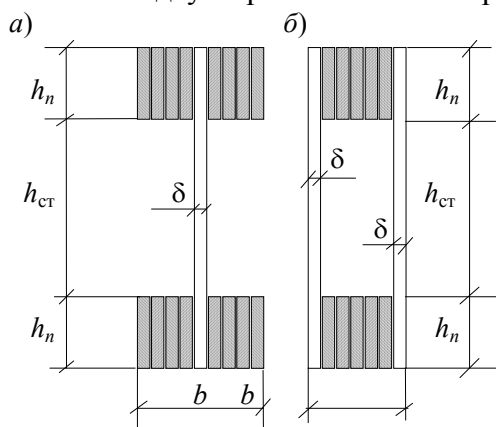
Поперечные сечения клееных балок с плоской фанерной стенкой.
